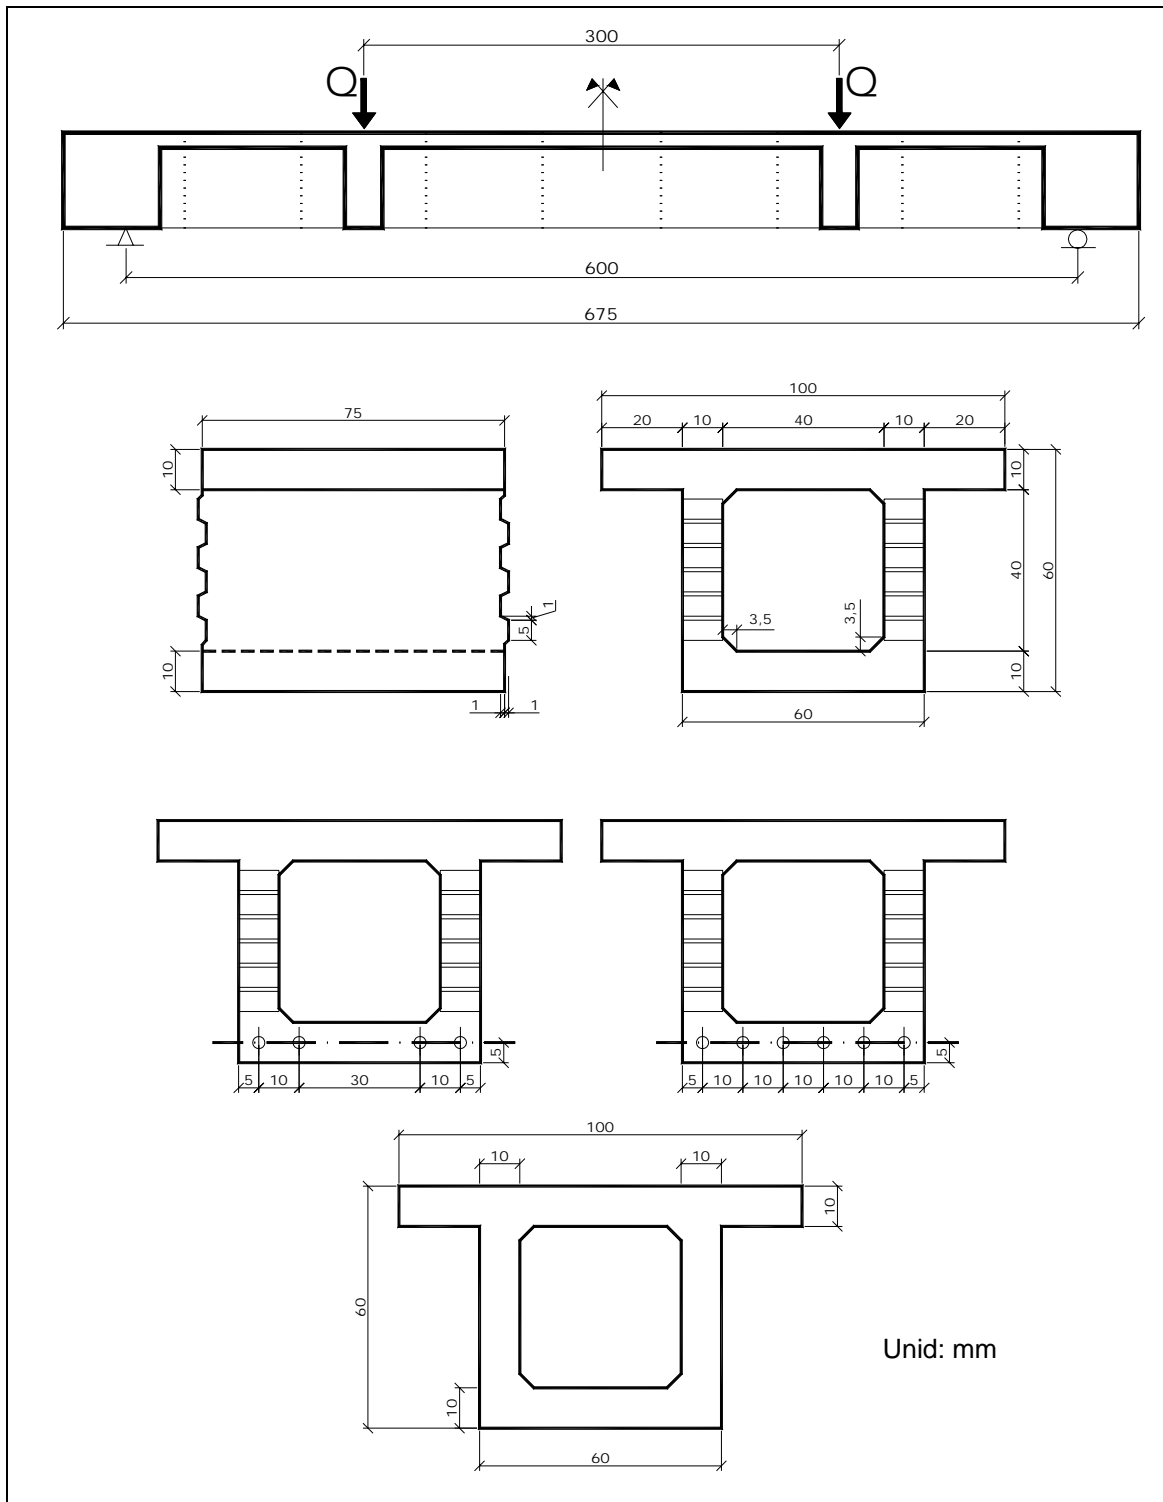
Elevação longitudinal das vigas ensaiadas e seção transversal (monolíticas ou com 9 aduelas)
